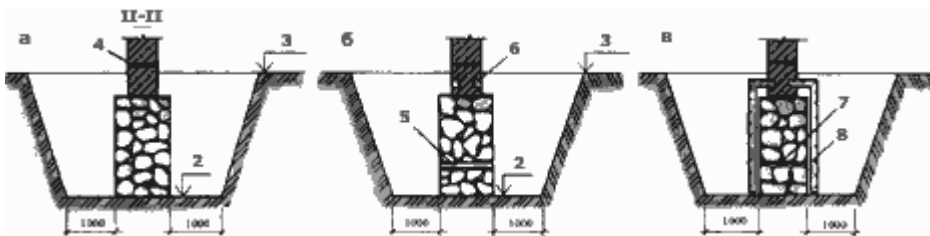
Усиление ленточных фундаментов: а - ленточный фундамент в отрытой траншее; б - устройство штрабы и пробивка отверстий для анкеров; в - установка анкеров и арматурной сетки; 1 - первый участок по ремонту или усилению фундаментов; 2 - отметка заложения фундаментов; 3 - планировочная отметка земли; 4 - гидроизоляция; 5 - разгрузочная металлическая балка; 6 - поврежденная и просевшая часть фундамента; 7 - новая кладка; 8 - утрамбованный со щебнем грунт.
